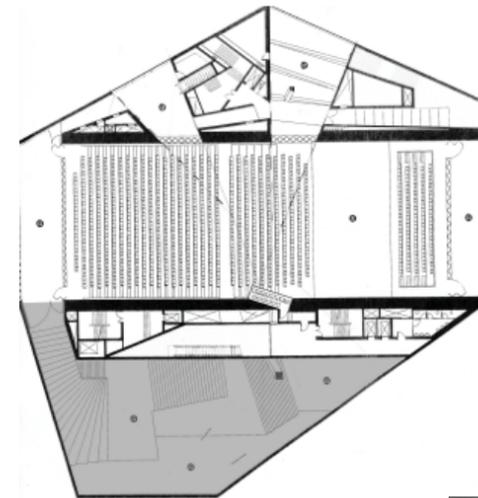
Stiegenanlage, Grundriss, Casa da Musica, Porto
